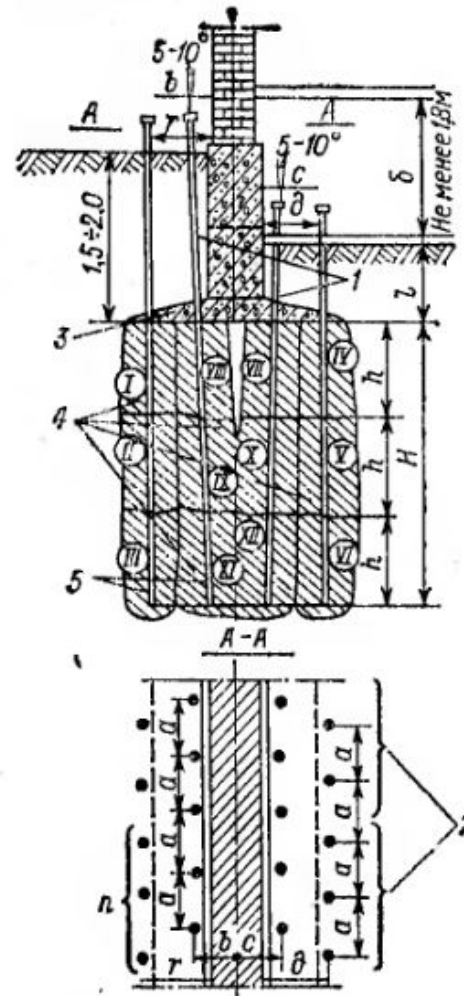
Размещение инъекторов при закреплении грунта под широкими сборными фундаментами
